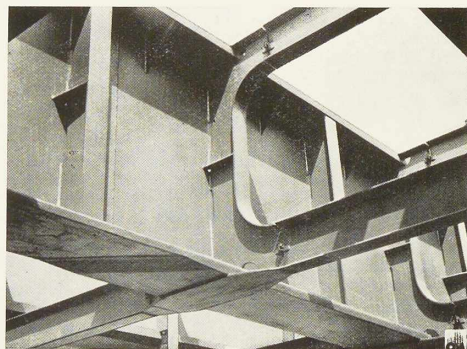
Détail d'une poutre soudée à âme pleine du pont d'Ougrée sur la Meuse. Ce pont entièrement soudé comporte six poutres principales d'une hauteur d'âme atteignant 3^m10; leurs semelles sont constituées par des plats à bourrelets. Le montage de ce pont est achevé. (Constructeurs : *Ougrée-Marihaye*, Soudure : *Arcos*.)
